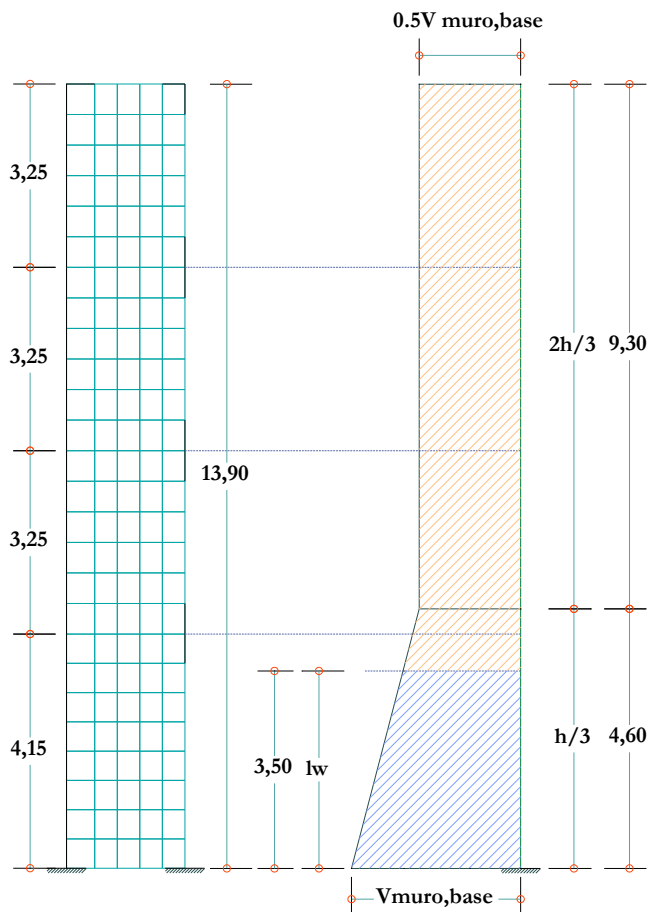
Envolvente para diseño por fuerza de corte para muros híbridos
